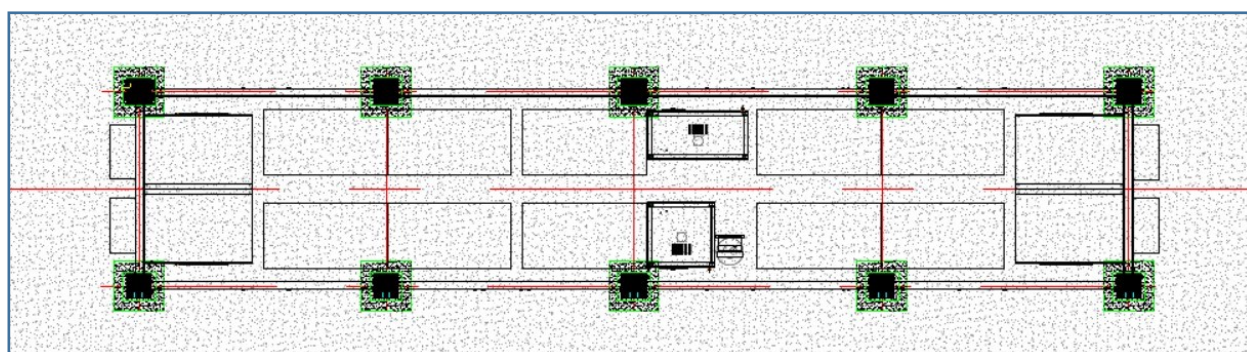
CABINATO PER BATTERIE (BESS) PROSPETTO PIANTA FONDAZIONI
